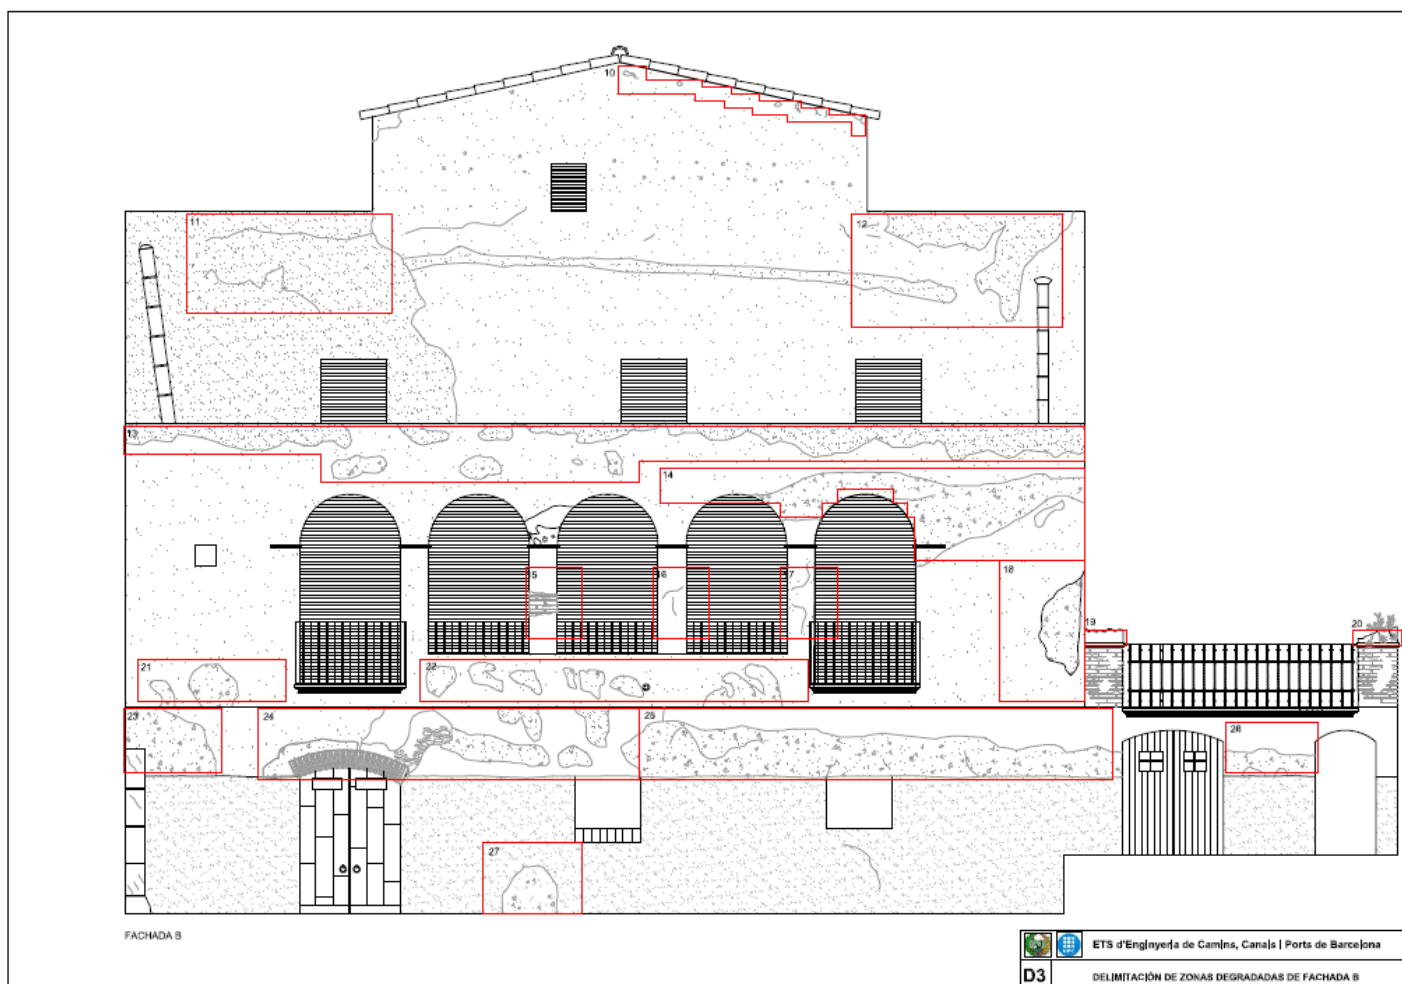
Caso real 4. Delimitación (1) de zonas degradadas de la fachada B
